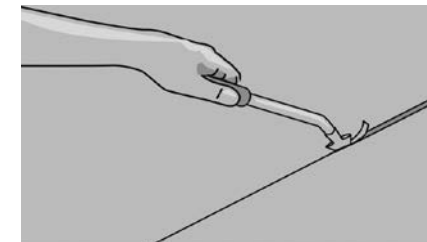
Рядом с водосточной трубой, отогните покрытие от трубы. Сделайте пометку на покрытии, где находится середина трубы. Вырежьте на отогнутом покрытии отверстие. Нагрейте виниловое покрытие и прижмите его к трубе. Обрежьте излишки крючковым ножом так, чтобы стенки трубы были закрыты.
